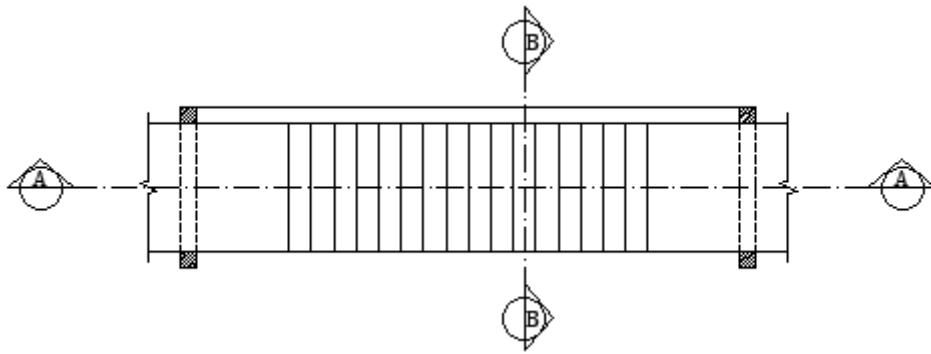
Vista superior da escada dimensionada, com a localização dos cortes AA e BB (Fonte: autor).
